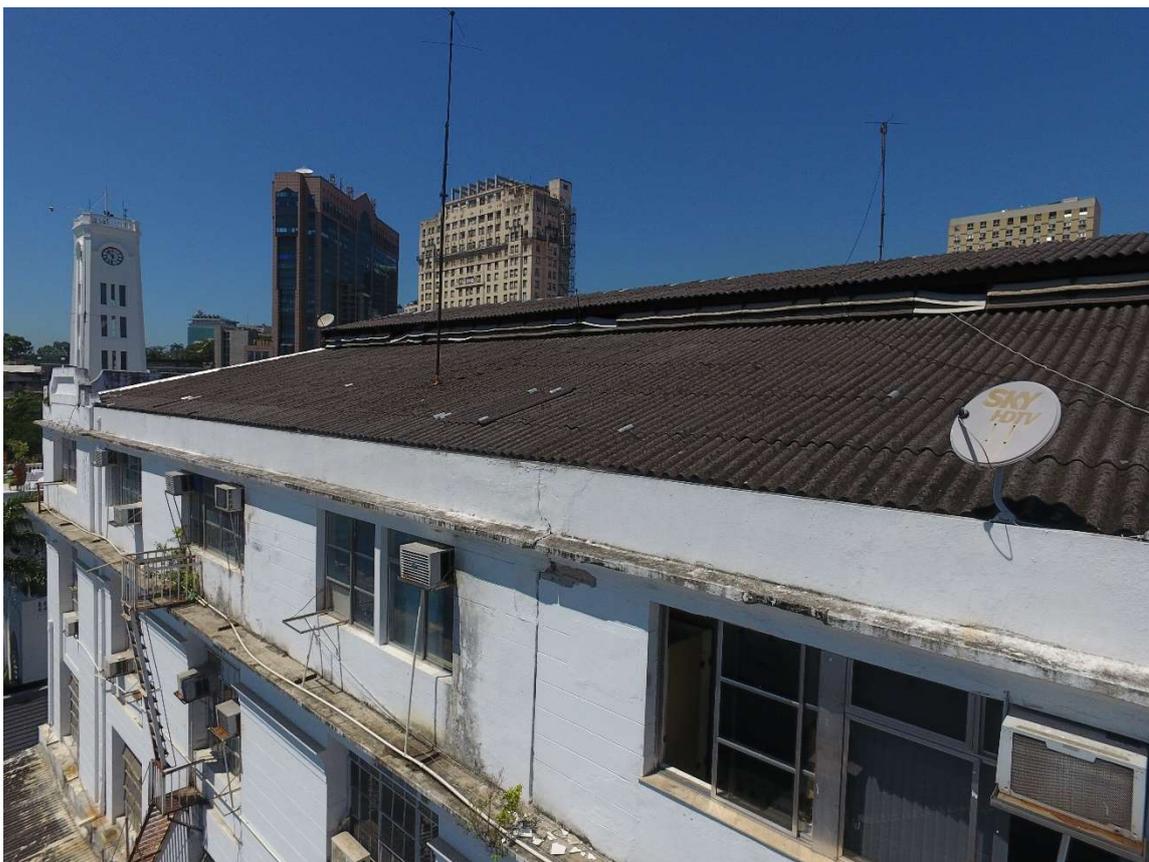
e 30 – FOTO AÉREA – Telhado SUPRIO – calha de coleta de águas pluviais e telhado com muitos pontos de reforço com manta aluminizada, demonstrando a necessidade de troca da calha e telhas (Causa: falta de manutenção / Solução: reforma geral com troca dos componentes do telhado)
